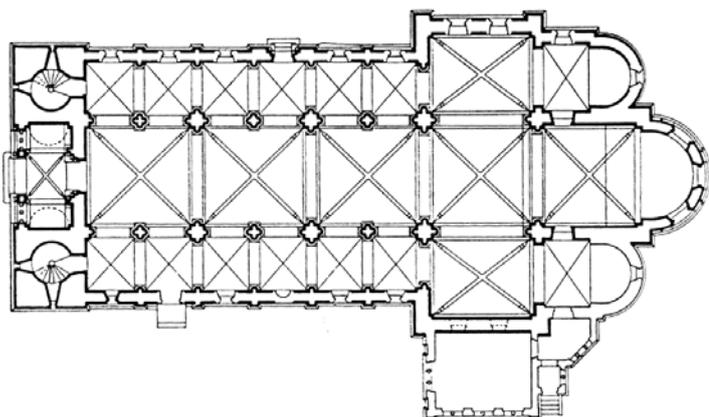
Grundriss von St. Fides in Schlettstadt im Elsass.
